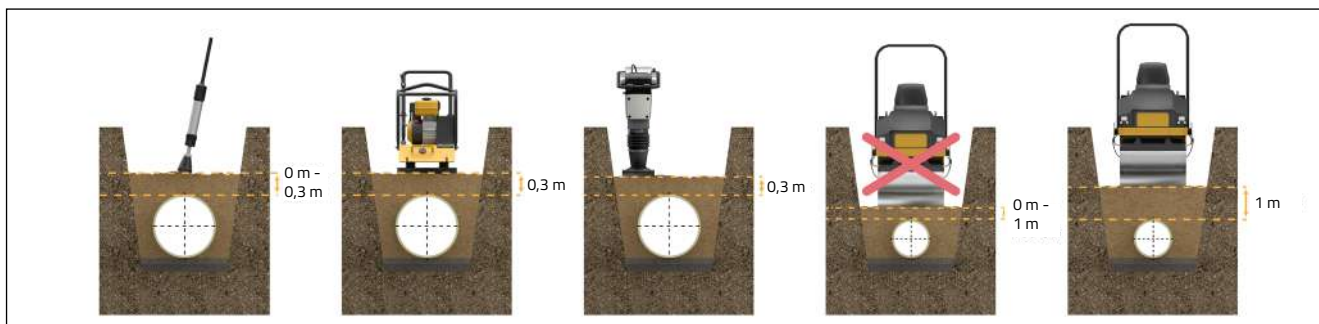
Altura mínima dos vários equipamentos de compactação.
